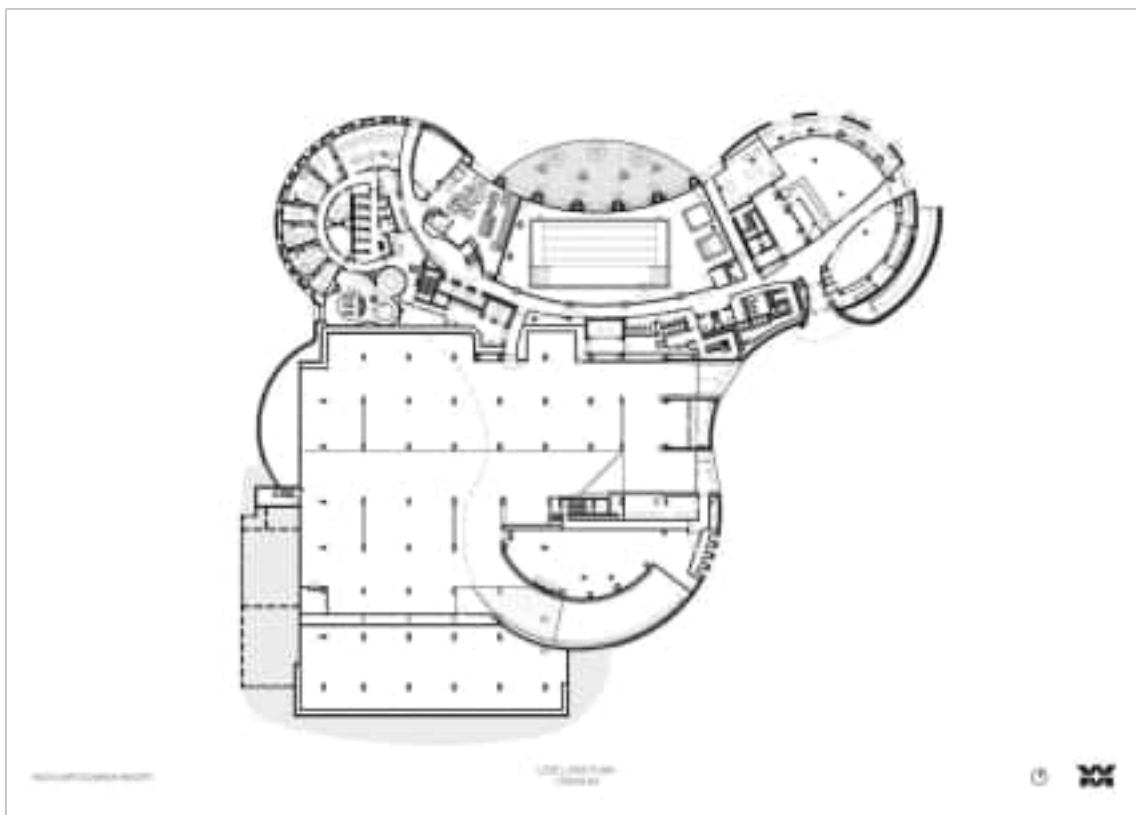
План 1-го поверху RACV Cape Schanck Resort / Wood Marsh [4]
